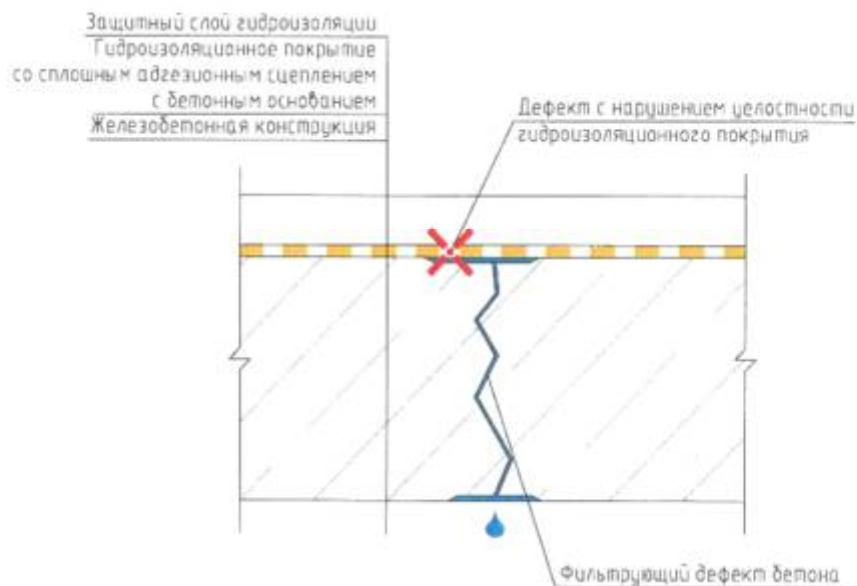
Дефекты гидроизоляционного покрытия с водопроявлениеми через дефекты бетона
